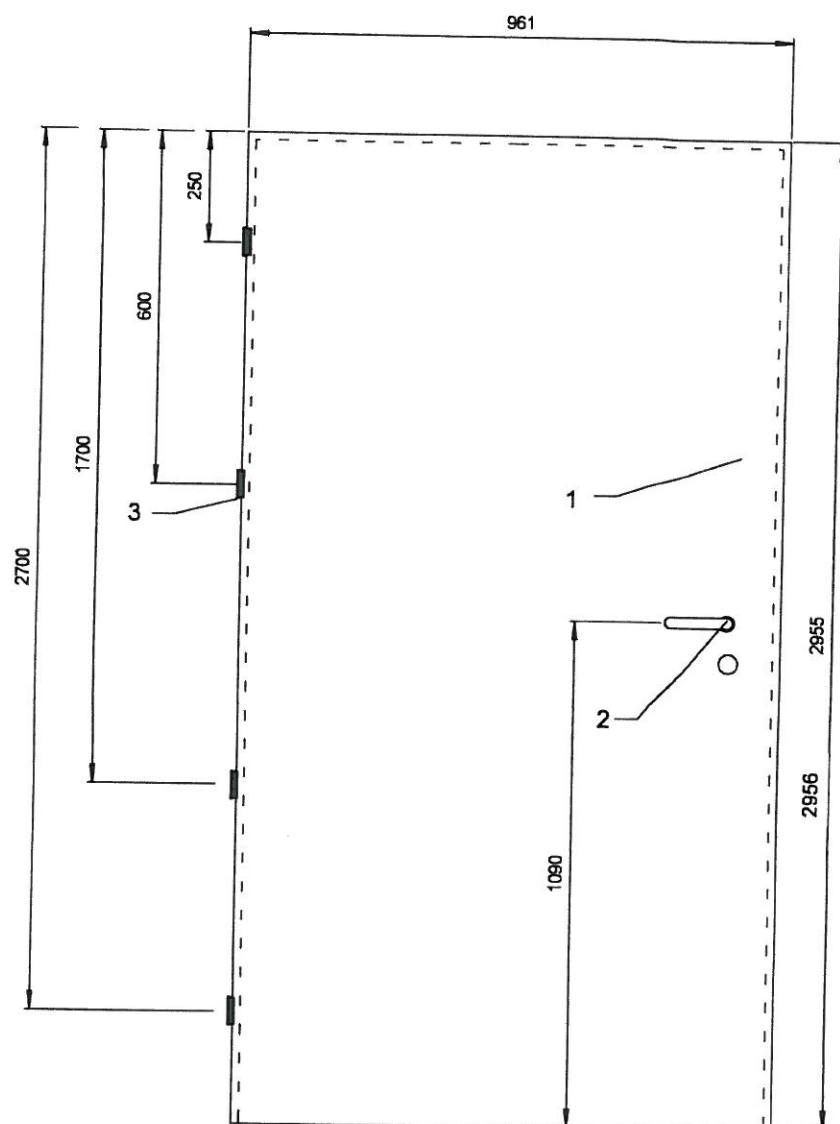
Przekroje przez drzwi wewnętrzne o oznaczeniu 01/W/17 F
